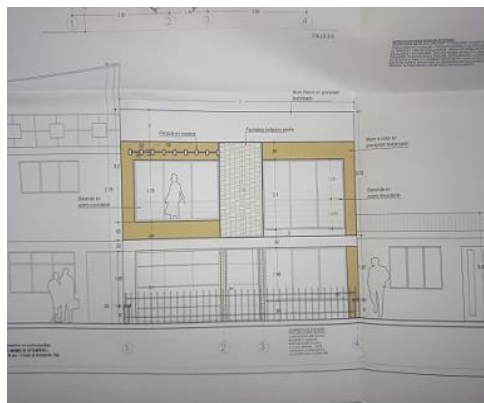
Fachada (calle 8ª) /fuente: Propia.
